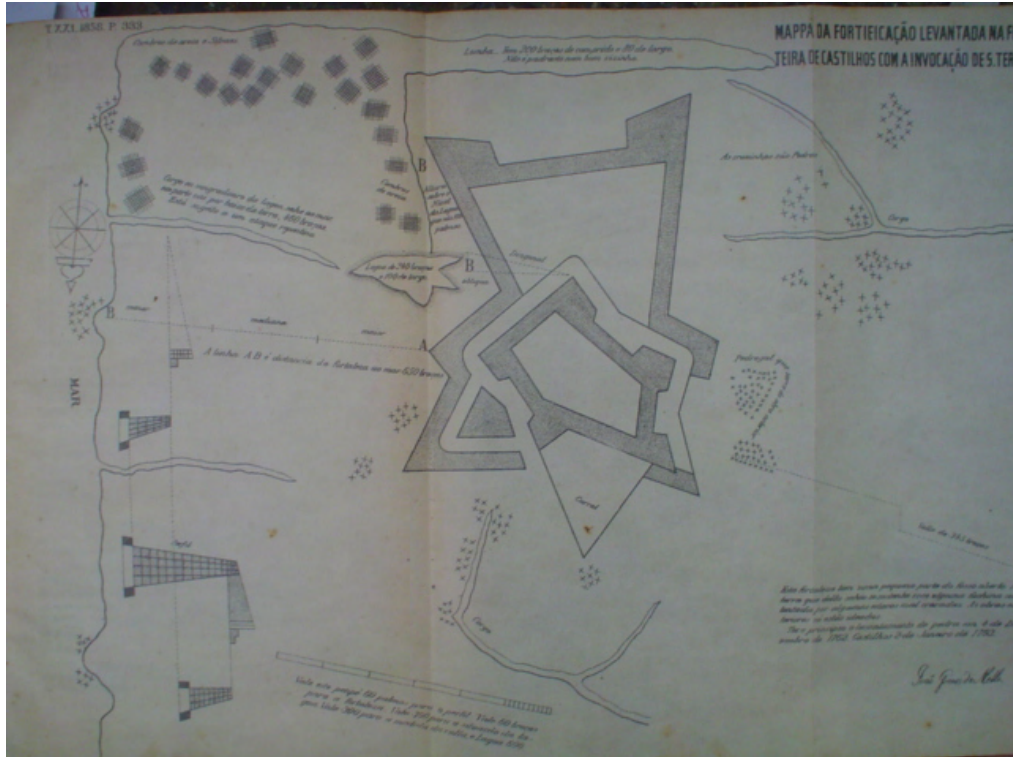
Planta 1 - Santa Teresa (1763) por João Gomes de Mello²⁷⁰
